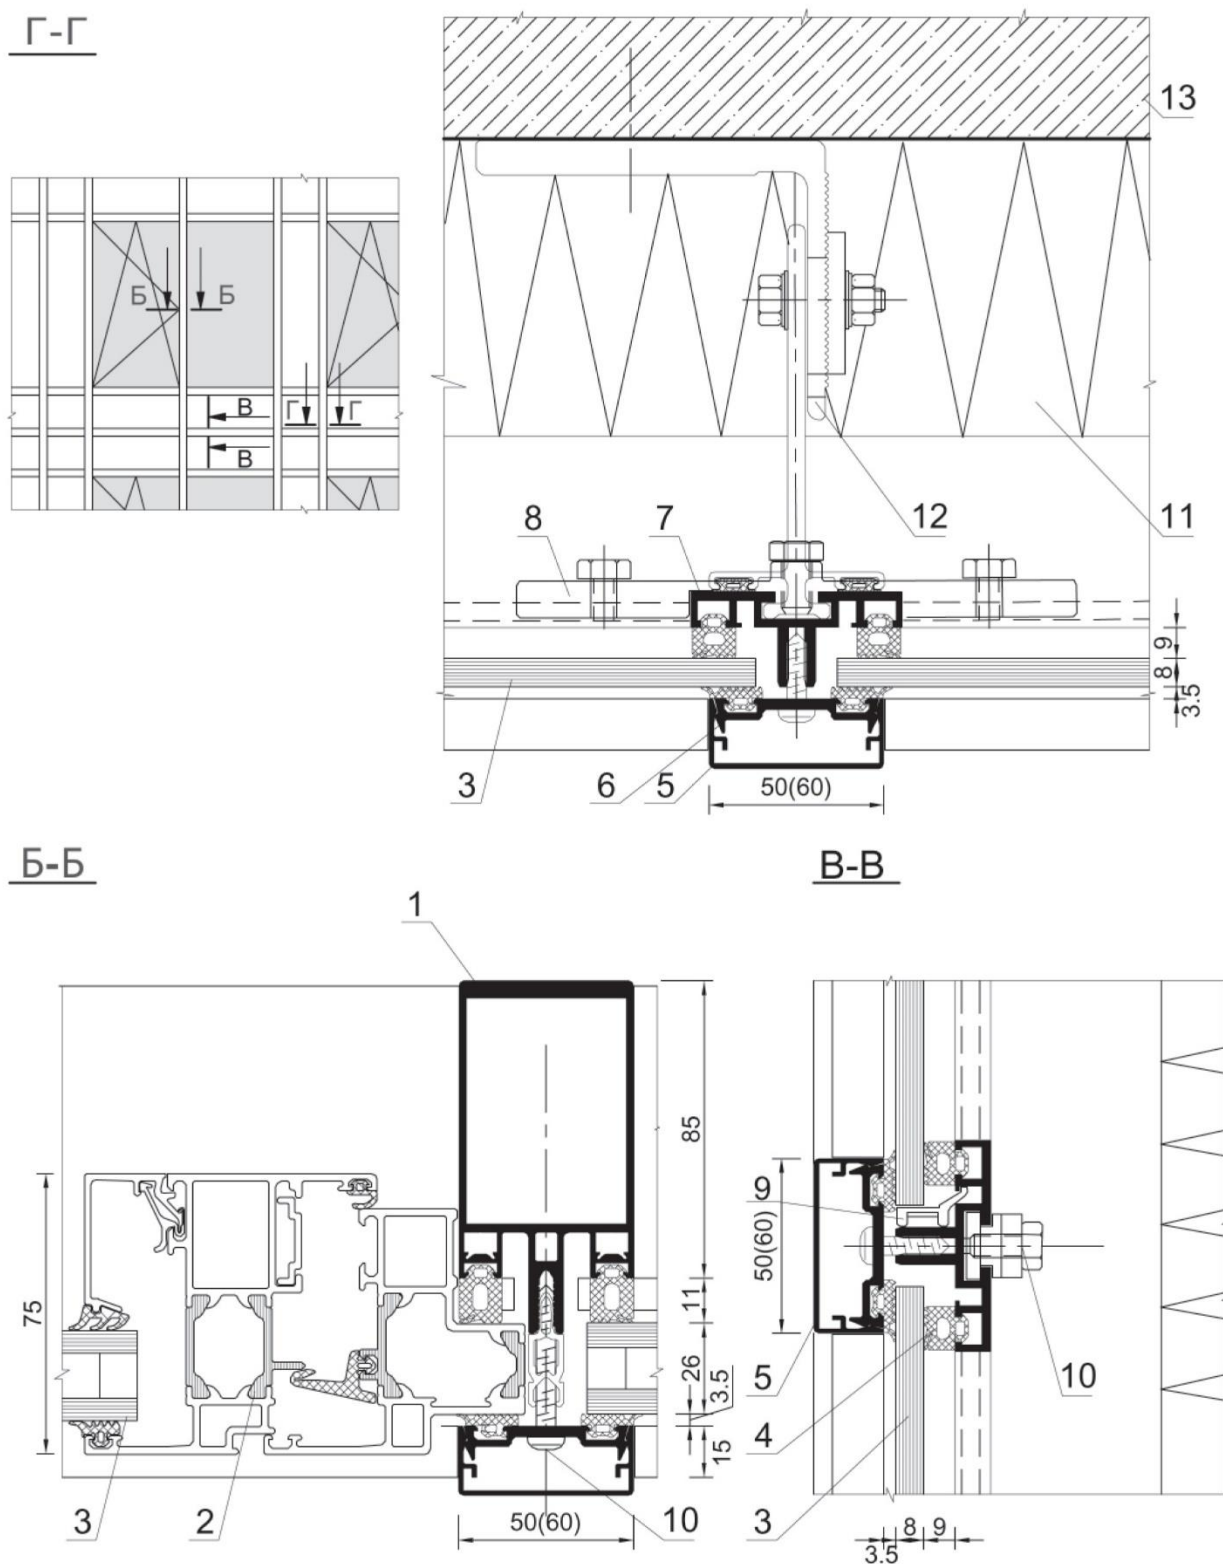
Деталі фасадної системи “тепло-холод” [9]
